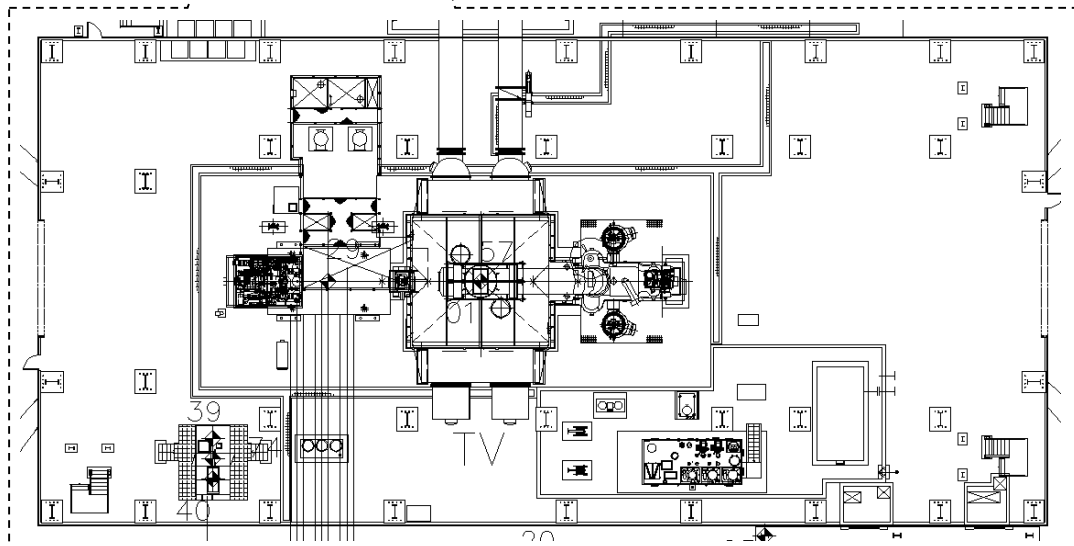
Vista en planta de Casa de Máquinas de la Central 264 CC Centro.
